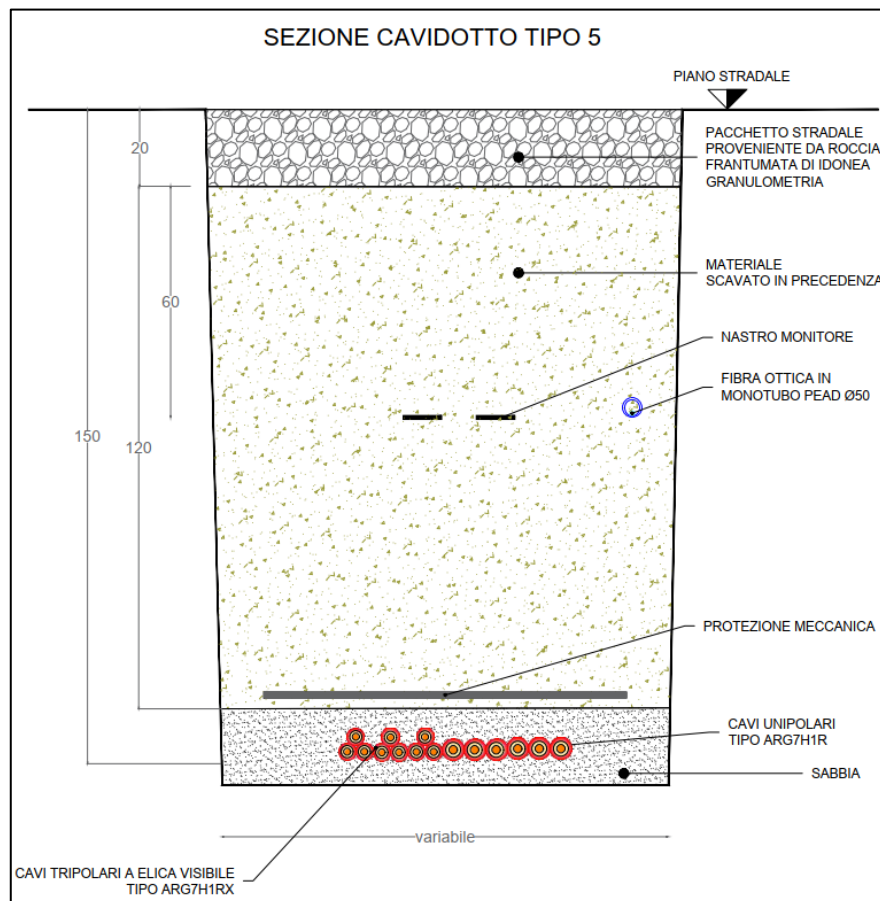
Sezione di posa cavidotto MT a 30 kV – tipo 5
